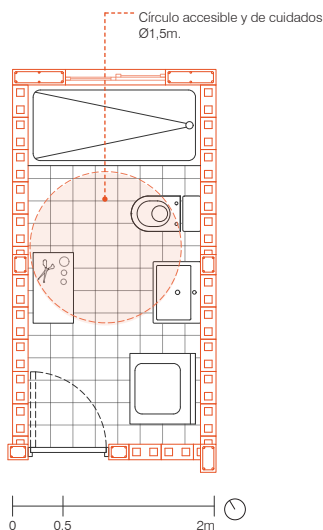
Plano baño 1 de Casa Maripangue. (Elaboración propia en base a planos de Muñoz, 2021 y visita a terreno).
